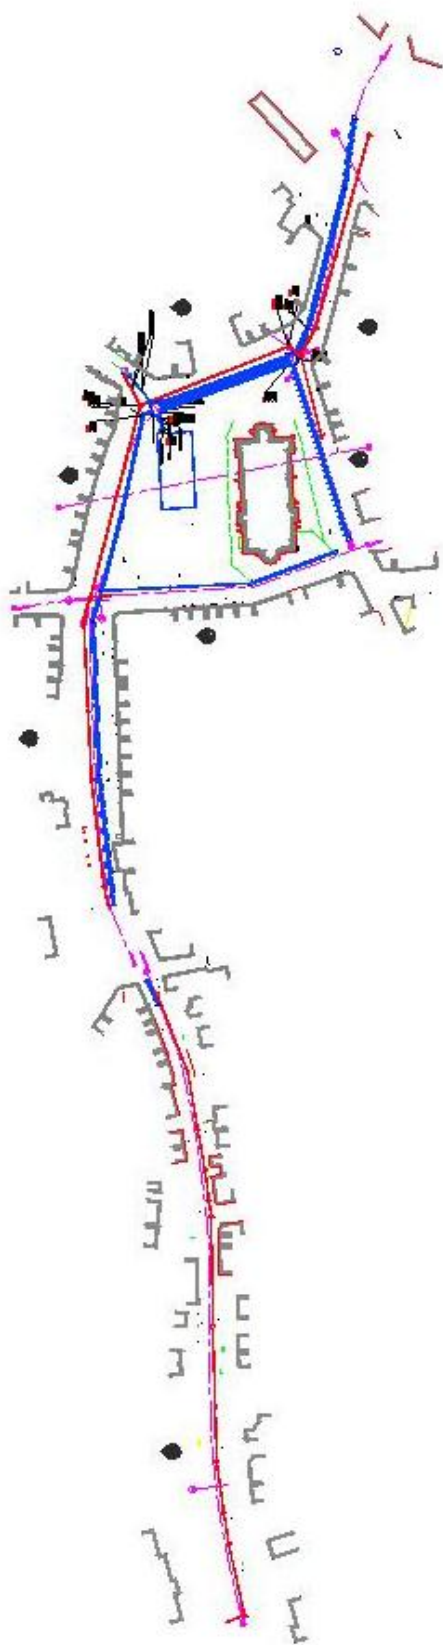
Plan van de geplande werken rond het Gemeenteplein.
